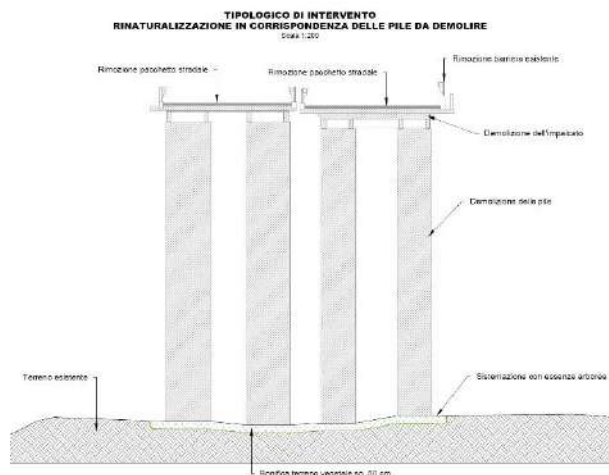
Sezione tipo rinaturalizzazione in corrispondenza delle pile da demolire
